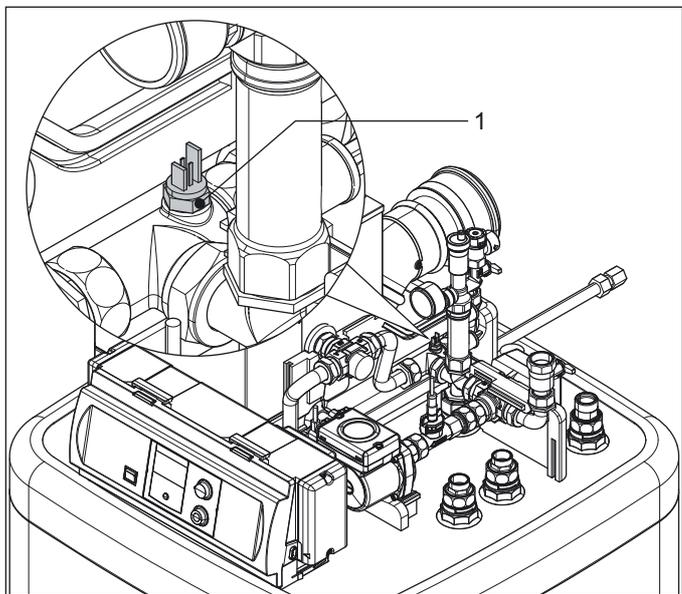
Wärmedämmungen ausbauen - 5.+ 6.
